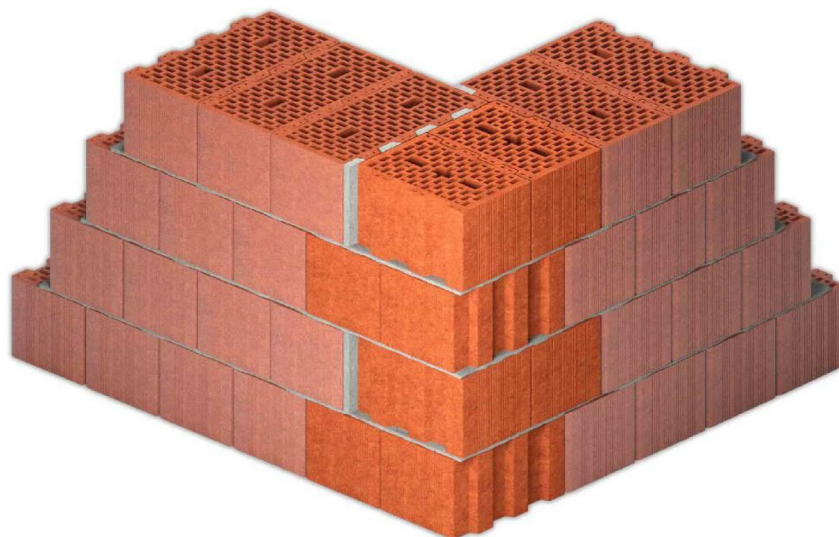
Фрагмент кладки стены из крупноформатных керамических блоков
